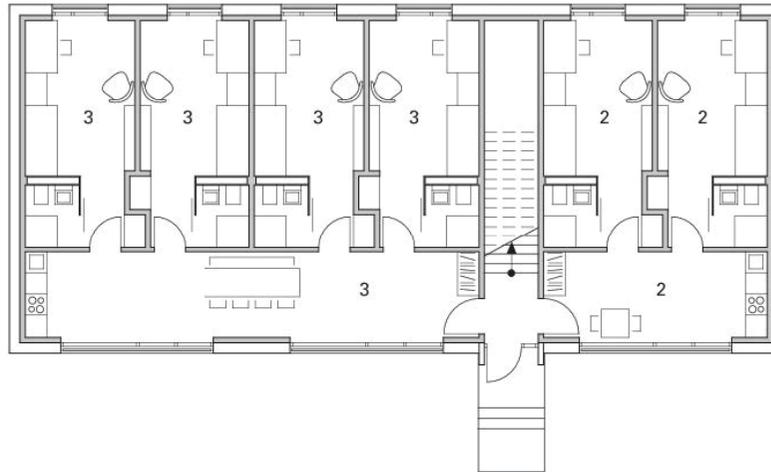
Grundriss 1. Obergeschoss Fuhlrottstraße Wuppertal Zeile, Haus H 2
